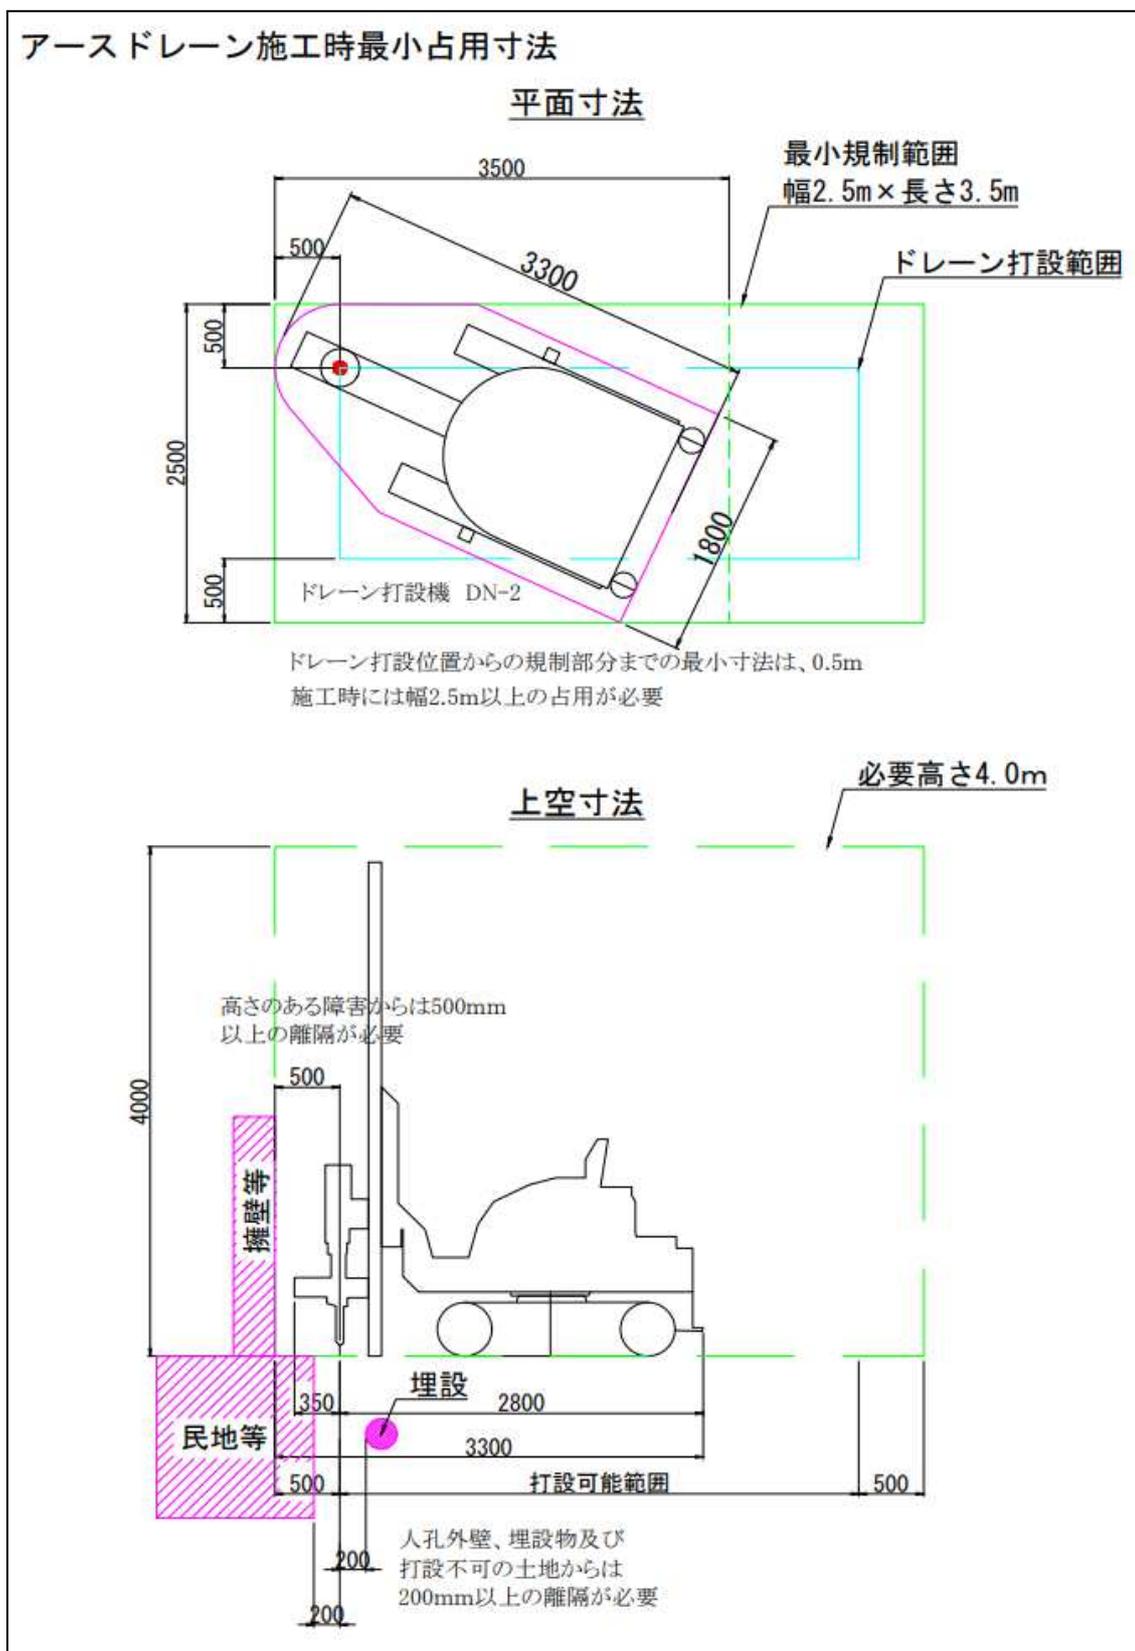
ドレーン打設 (DN-2・DN-3) 配置図
